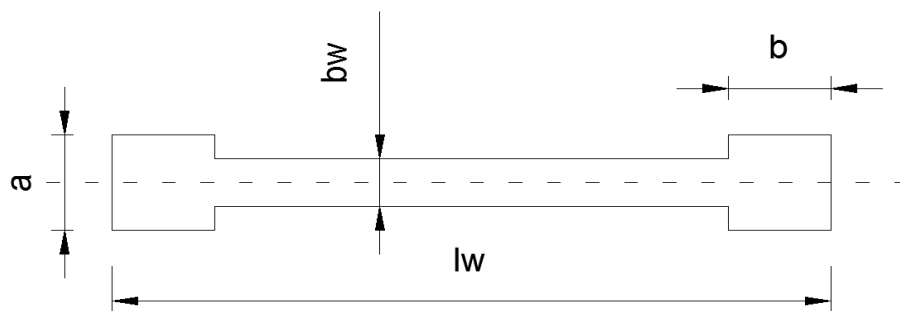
Vista en planta de los muros utilizados para el diseño de las edificaciones.
